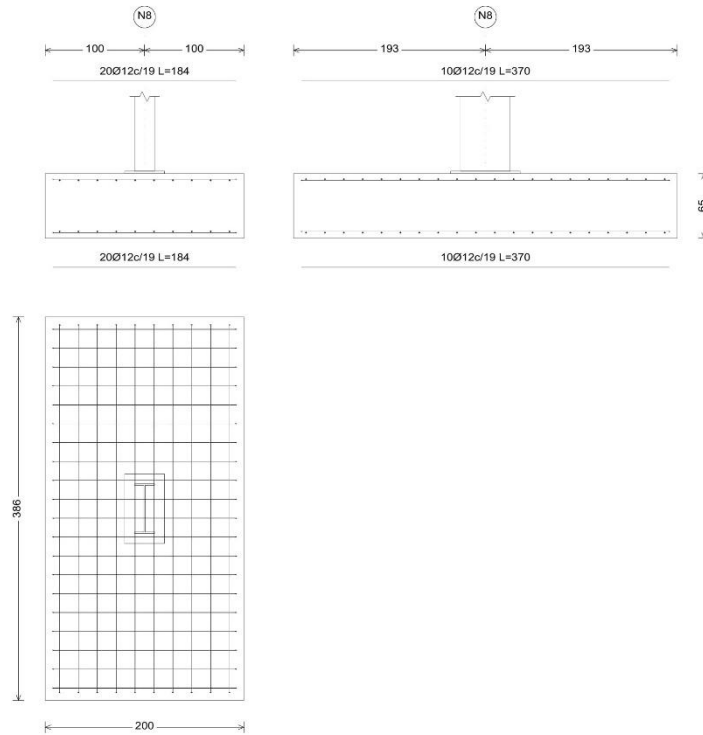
Zapata tipo 2. Fuente: Elaboración propia a partir de CYPE 3D
